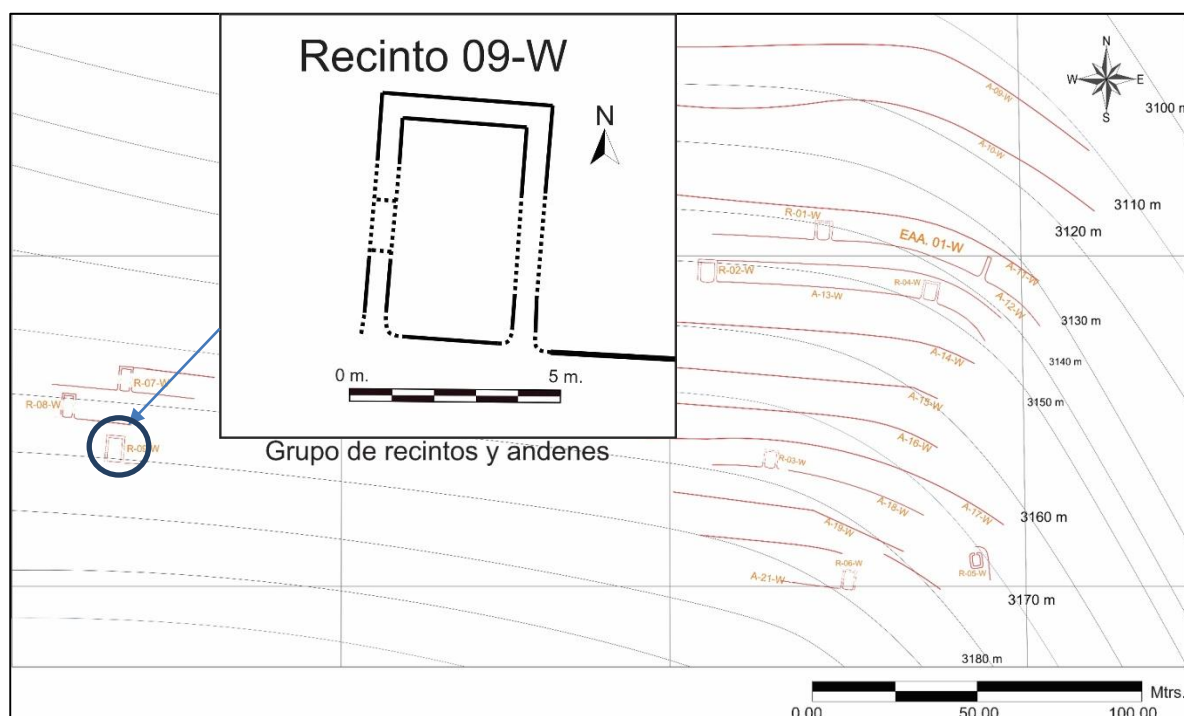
Plano de planta del recinto 09-W y su ubicación en el sitio de Waripata. Elaboración propia.
